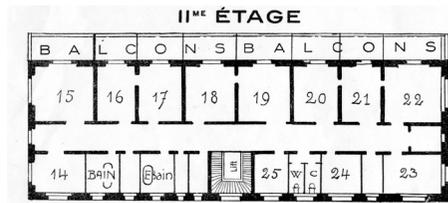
Territet, Clinique La Colline, plan d'étage, 1898 (AM).
